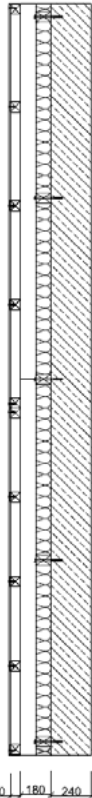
Structure de couches sur une sous-construction en bois pour la série de mesures de SWISSPEARL
